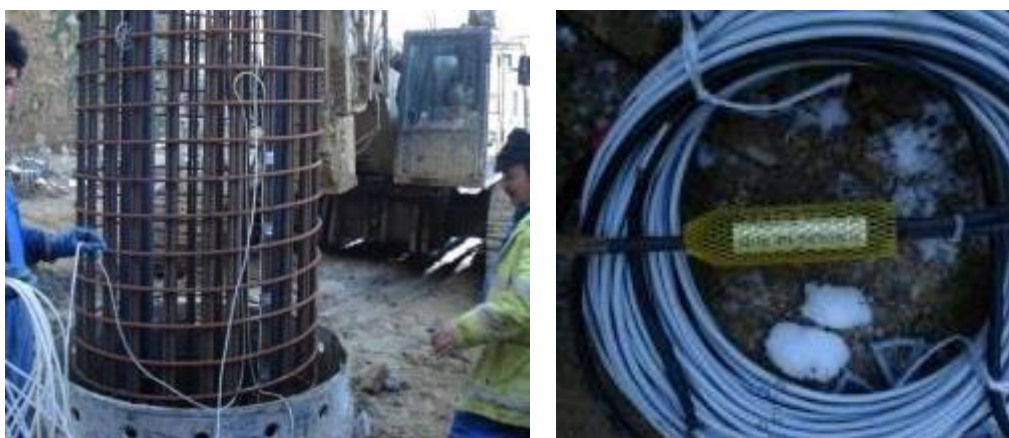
Extensometría en pilote. Viaducto de Pujayo (APIA XXI, S.A.).
